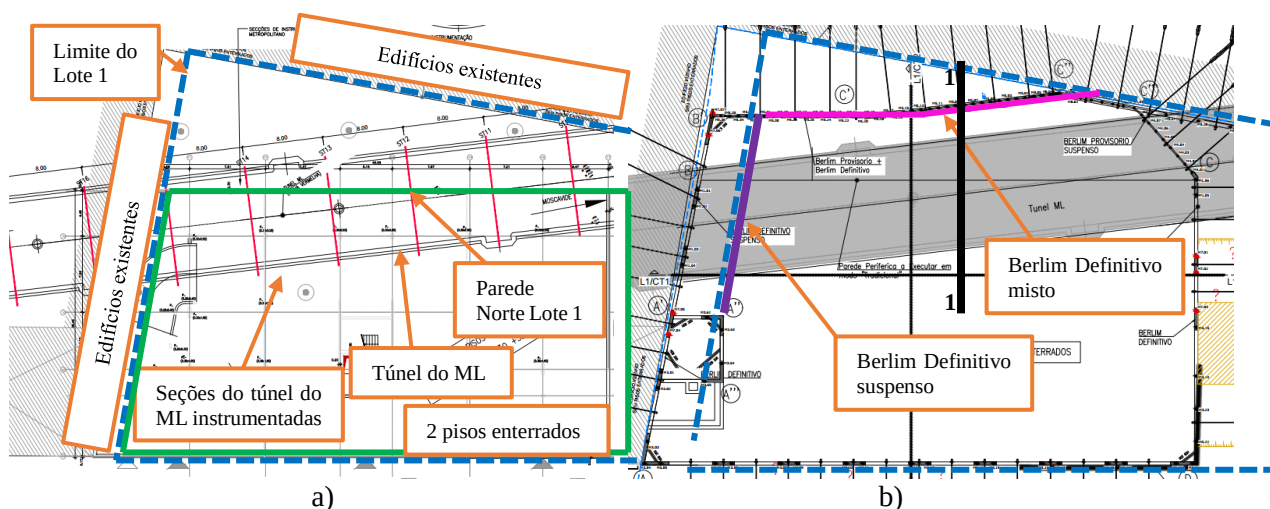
a) Planta de envolvente de condicionamentos do Lote 1. b) Soluções de escavação e contenção periférica para os alçados Poente e Norte.
